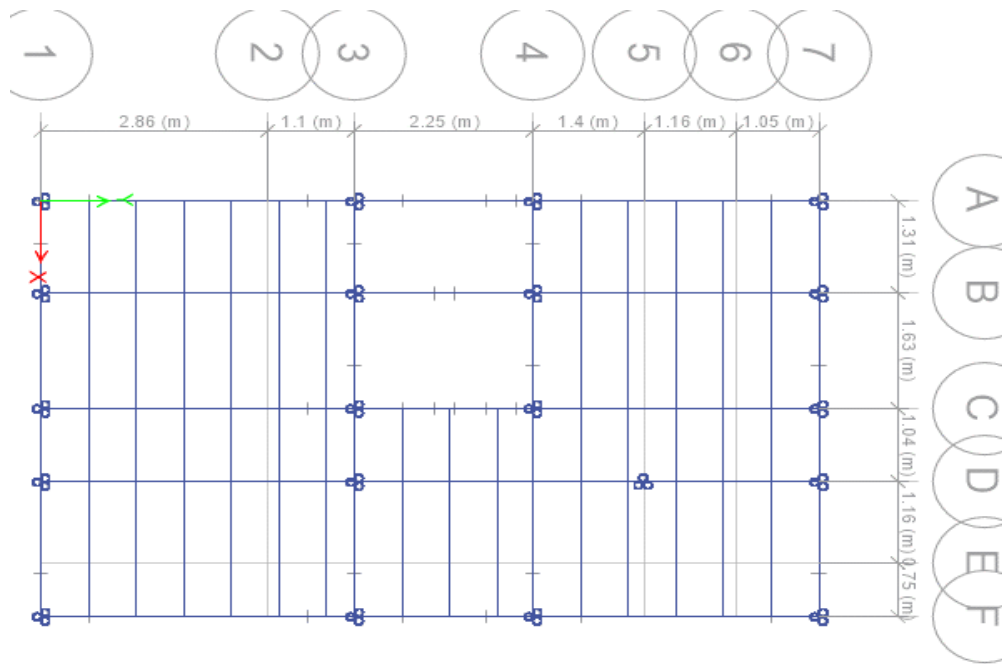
30: Vista de planta del modelo en Bambú piso 1
